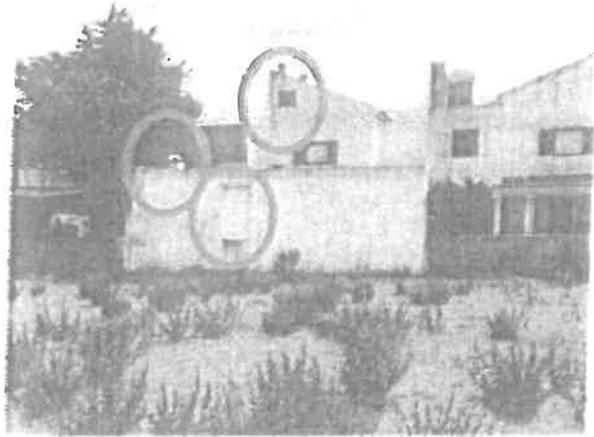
Vão de porta para lote privado, vão de janela ao nível do sótão e anexo.
